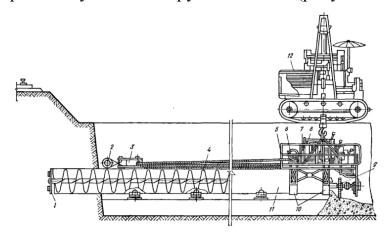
Принципиальная схема установок типа УГБ и ГБ [19]: 1 — режущая головка; 2 — упорный якорь; 3 — полиспаст; 4 — шнек; 5 — рама; 6 — лебедка; 7 — карданный вал; 8 — двигатель внутреннего сгорания; 9 — вал привода шнека; 10 — хомуты; 11 — прокладываемая труба; 12 - трубоукладчик
